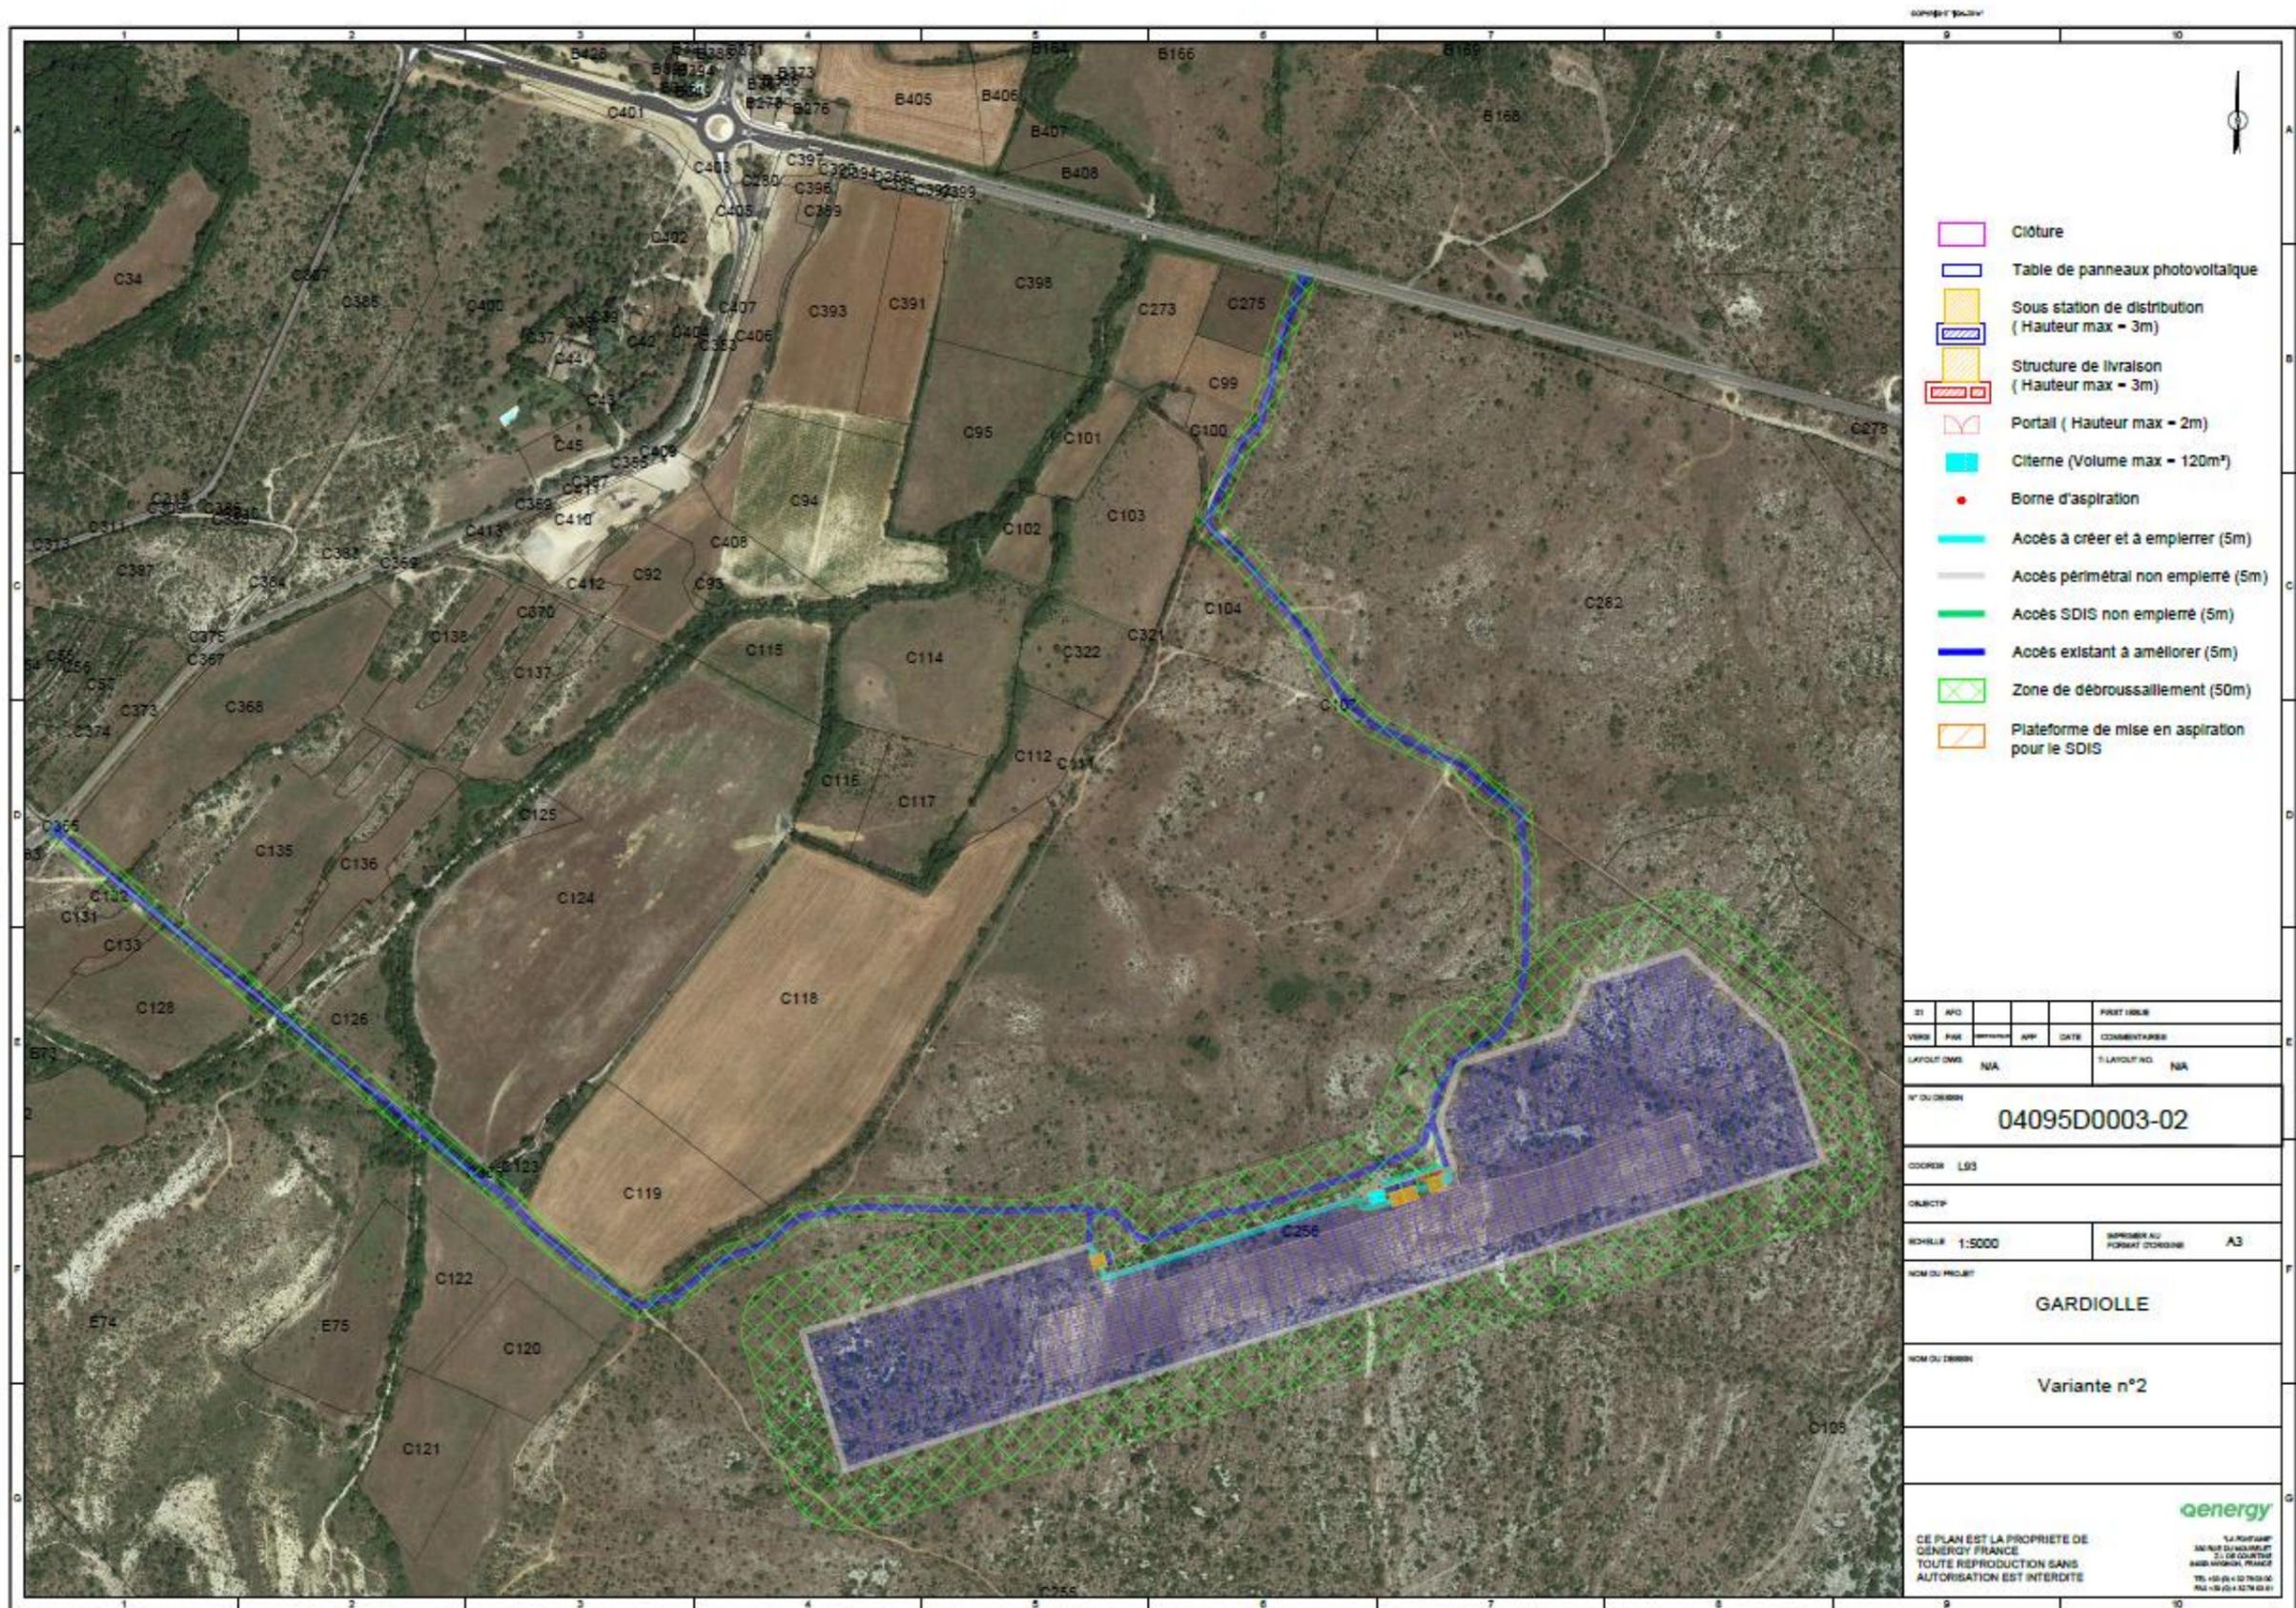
Plan de la variante n°2 du projet « Gardiolle »
